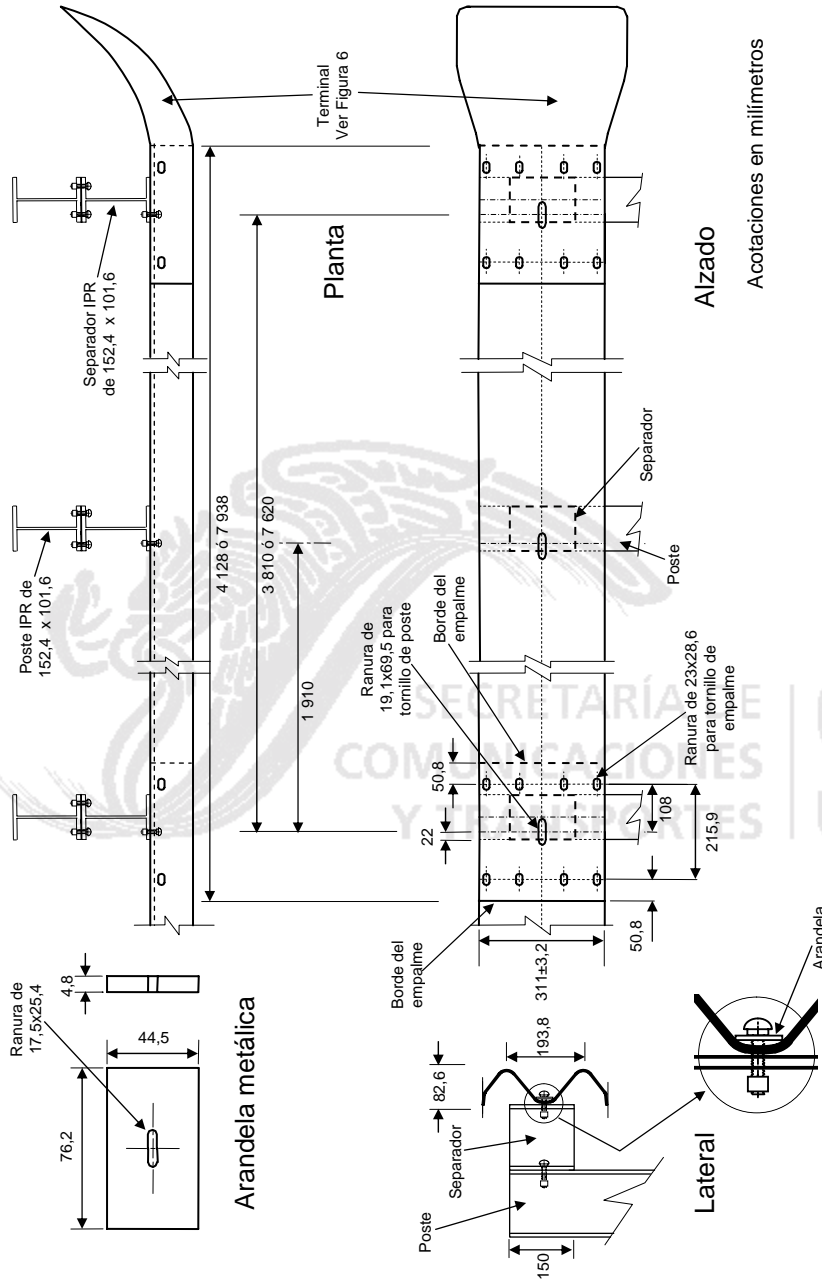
Sistema de defensa con vigas acanaladas de dos crestas
